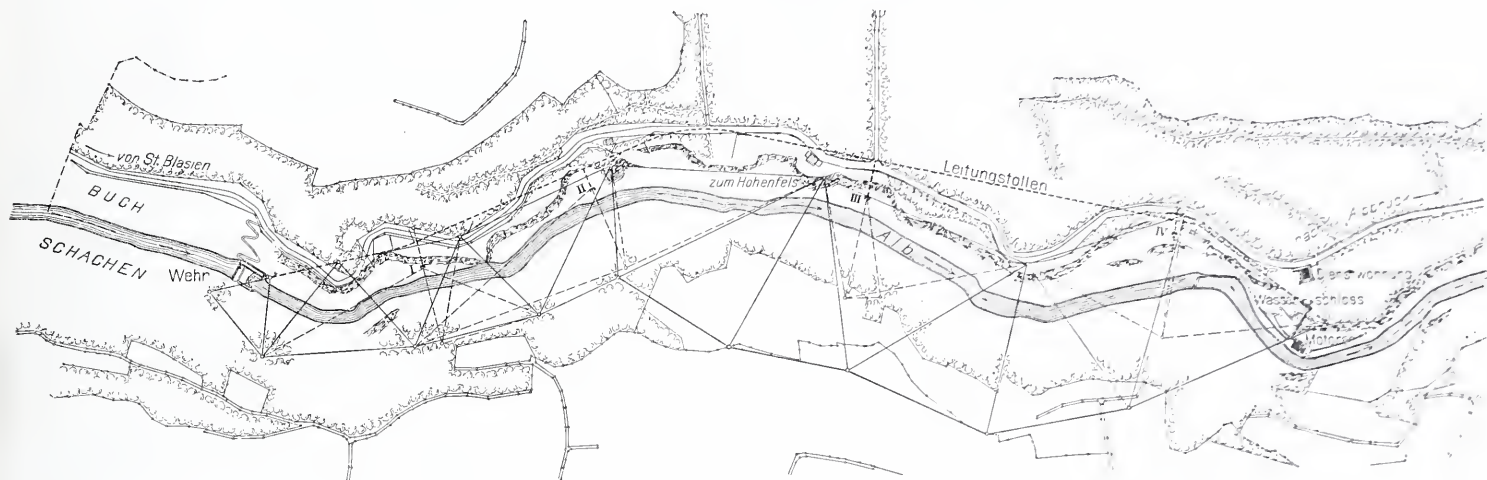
Lageplan mit der Triangulation für den Leitungstollen. — Masstab 1:10000.
